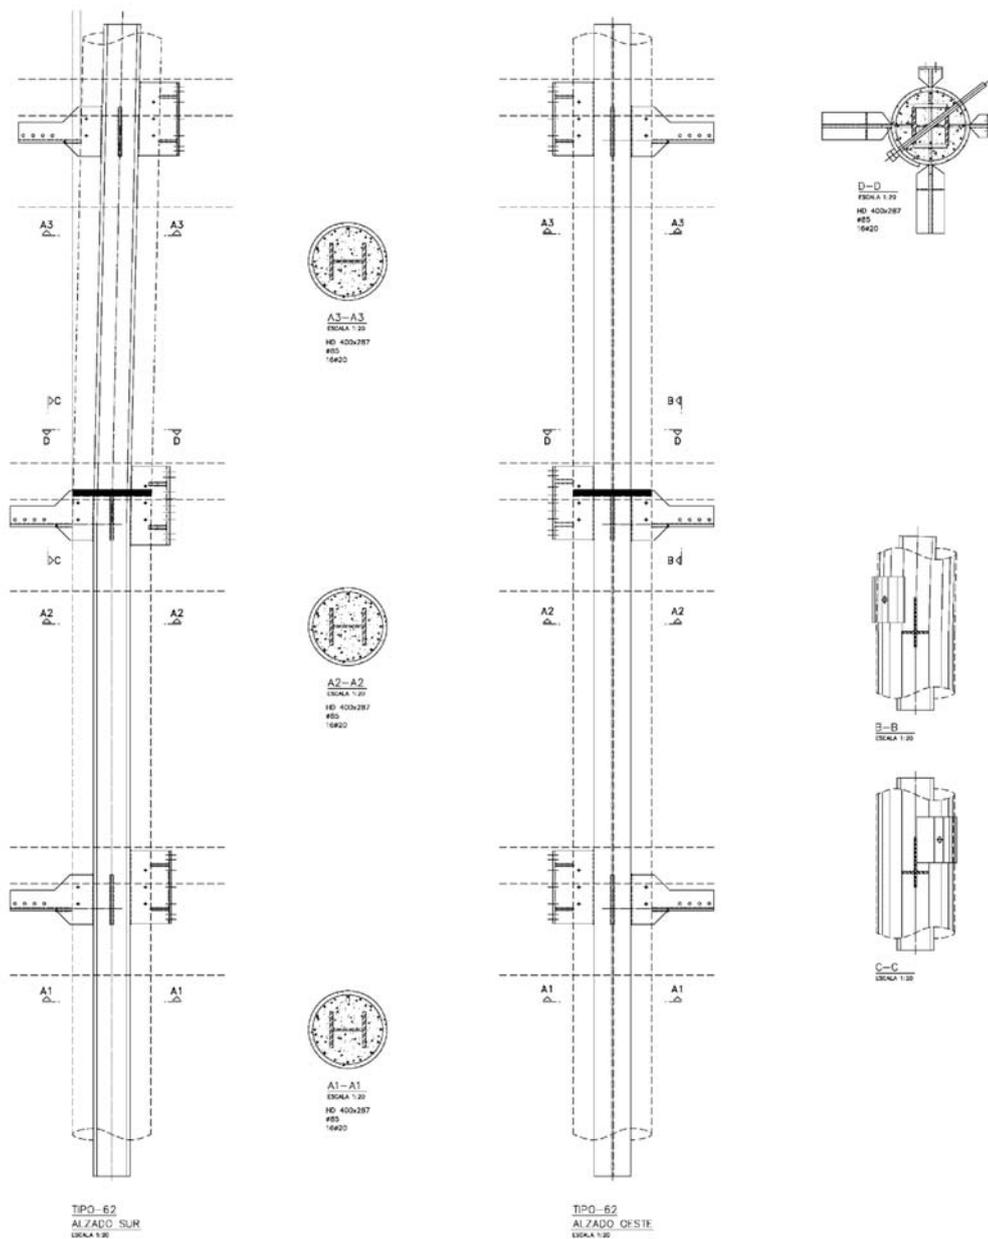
Torre de Cristal: perfiles metálicos embebidos en los pilares de hormigón armado.
